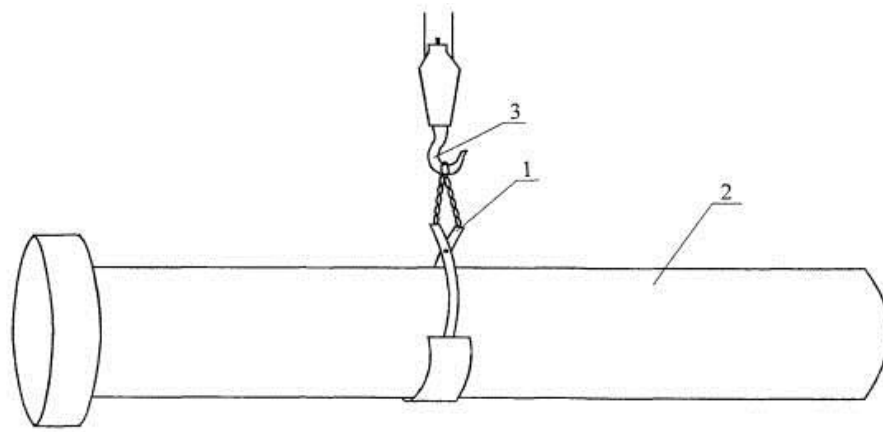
Строповка труб, где 1 - клещевой захват; 2 - труба; 3 - крюк подъемного механизма
